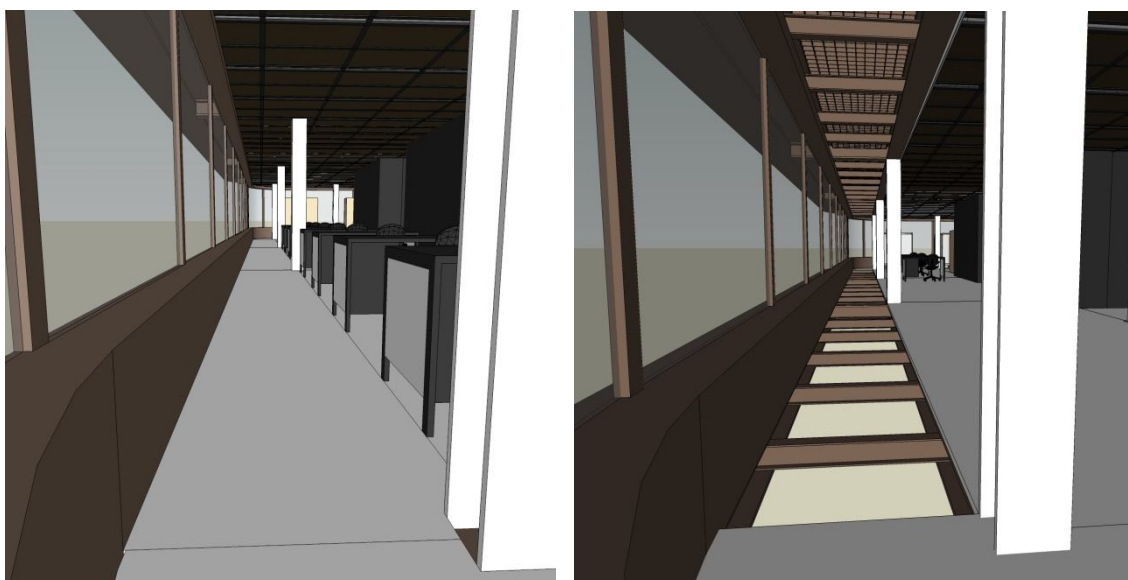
Corte da laje deixando a estrutura metálica à vista. Imagem do autor.
